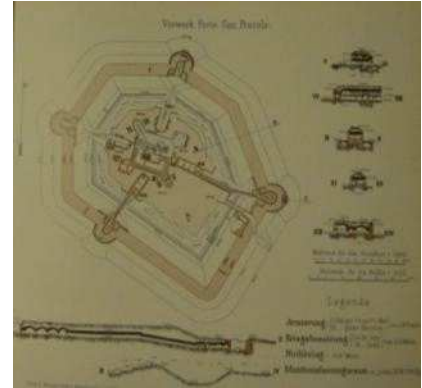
Pianta e sezioni austriache del forte San Procolo
